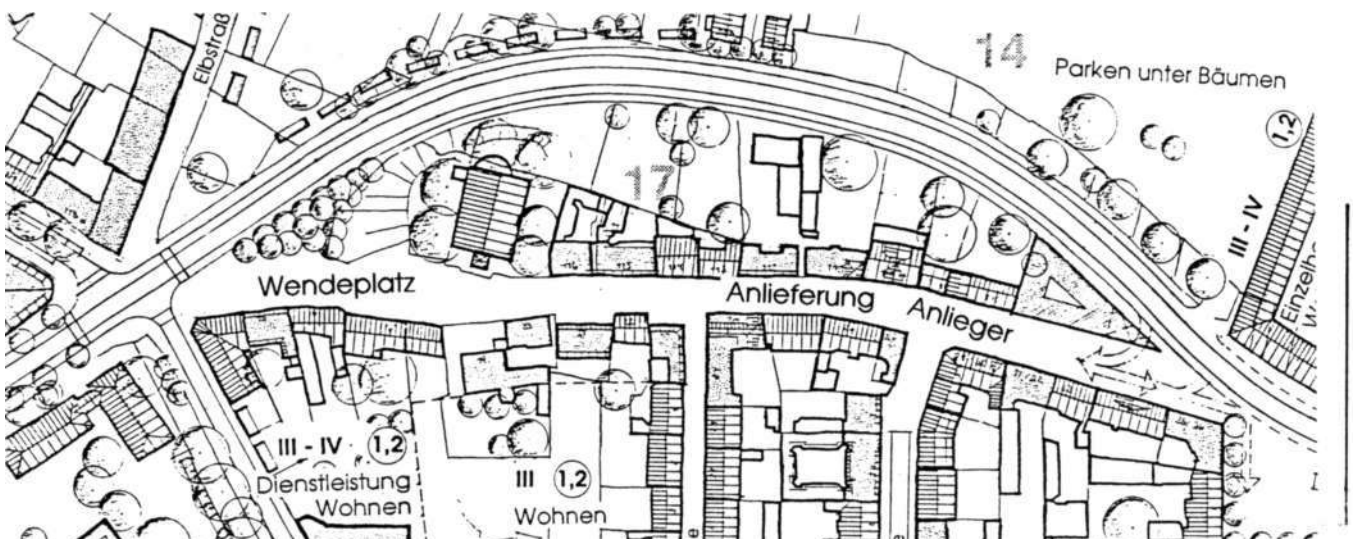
Schönebecker Straße/Variante 2b/PGT:
